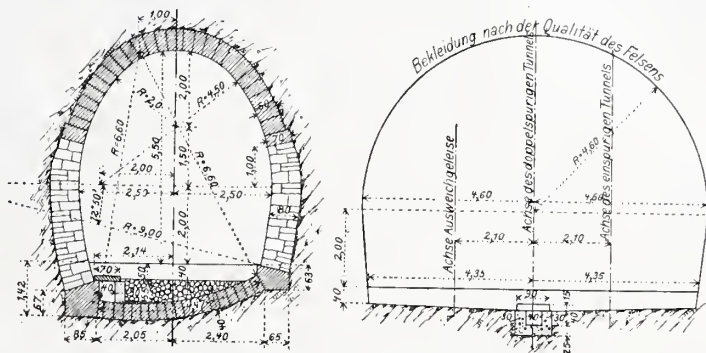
u. 7. Tunnelprofile zu Projekt I. — 1:200.
